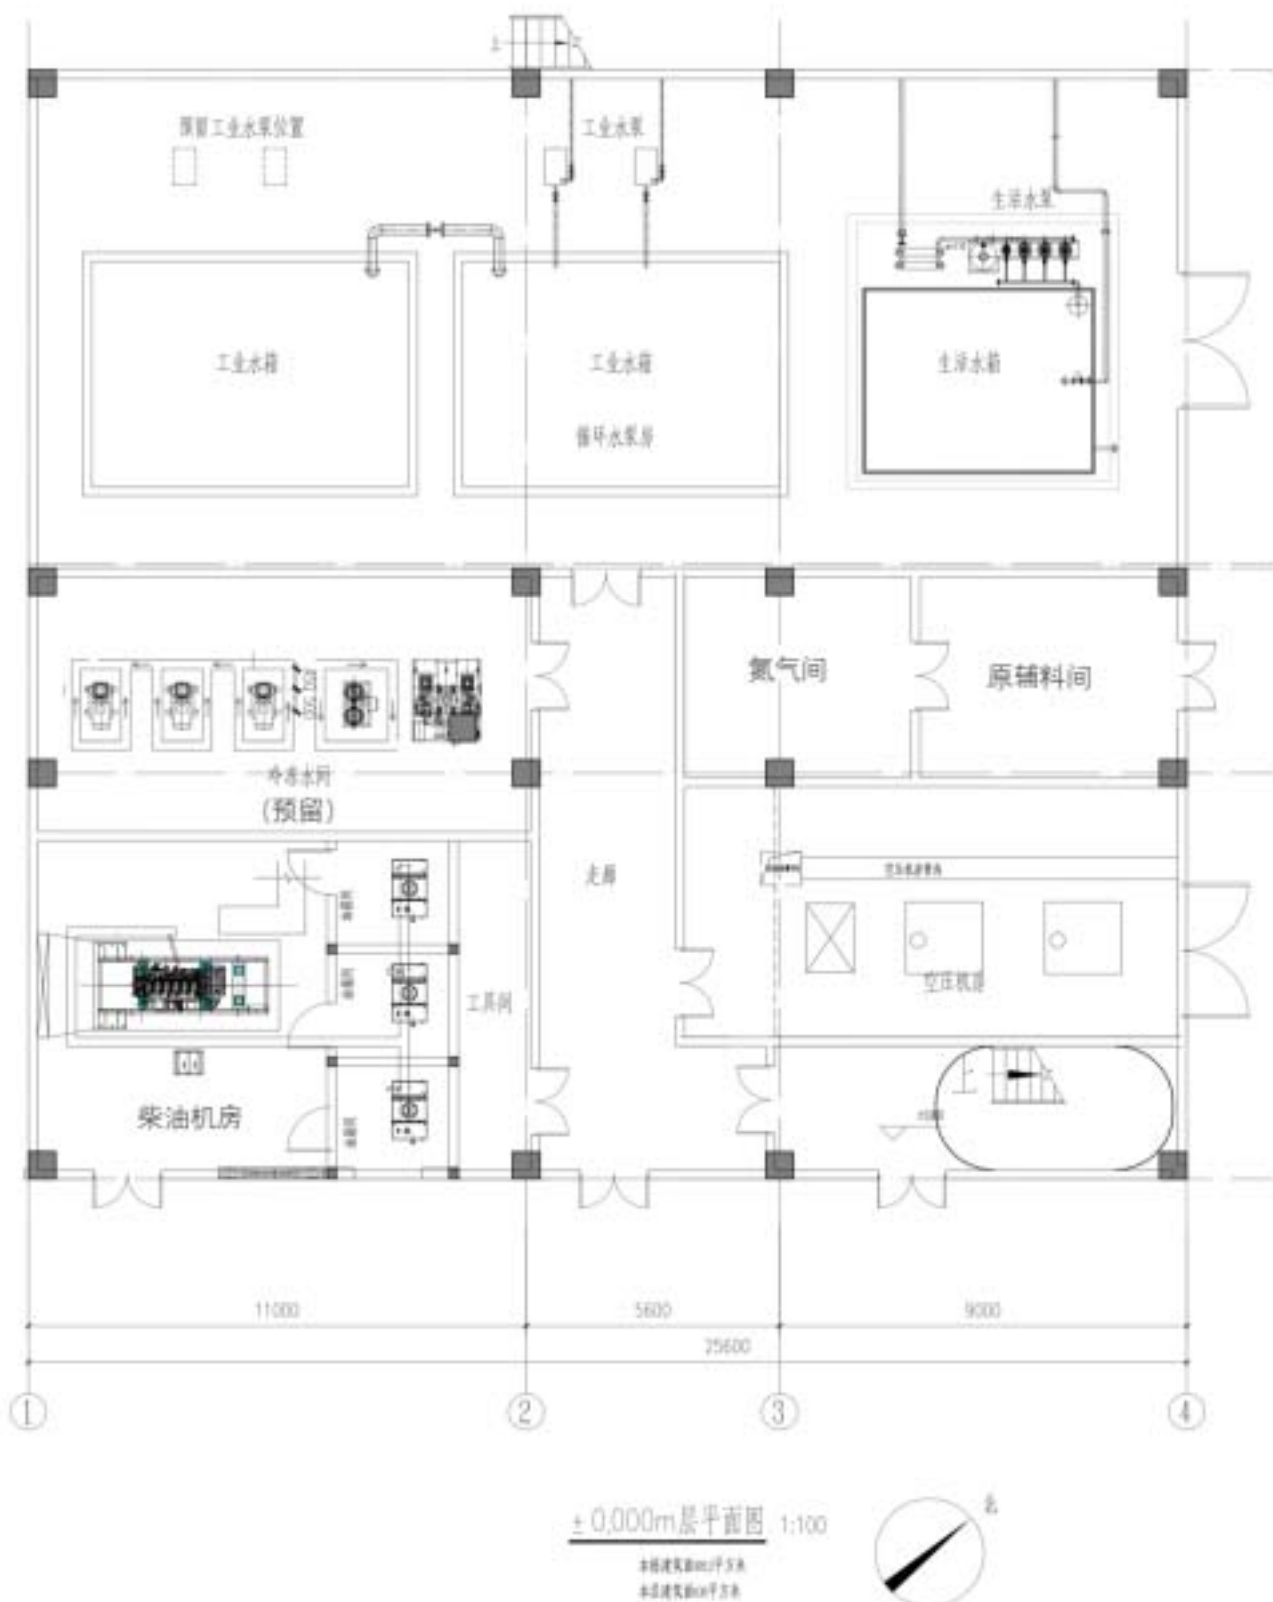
辅助生产楼±0.000m 层平面布置示意图
